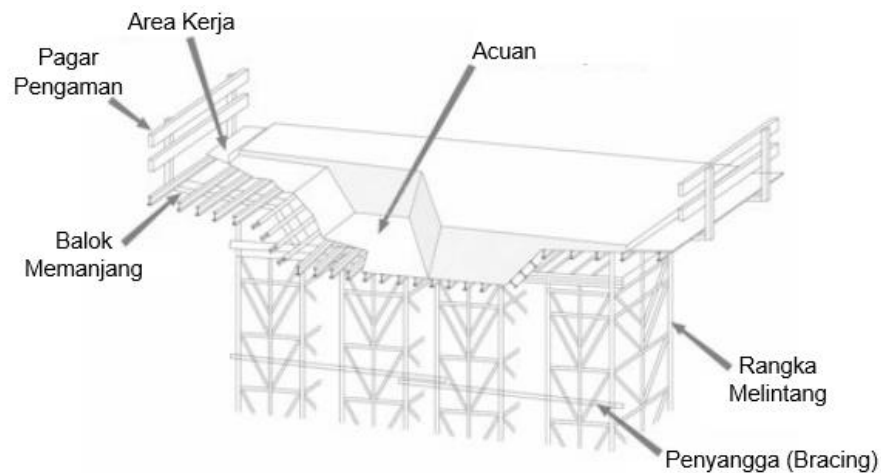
Perancah penopang jembatan (*bridge shoring*)
